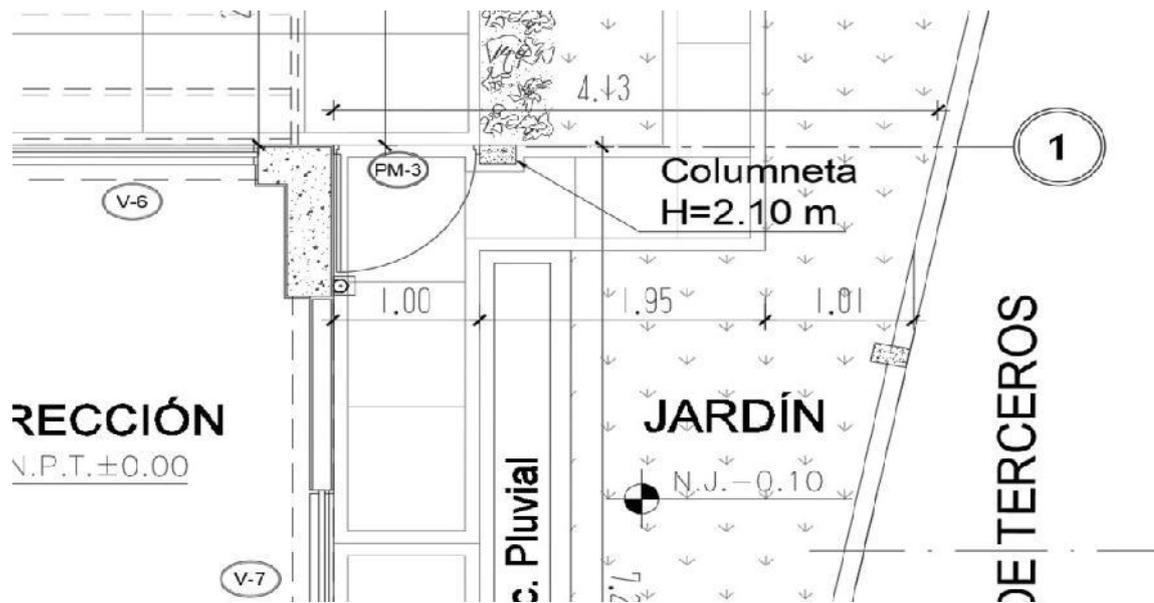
Vista en planta del planeamiento general en el plano A-01
